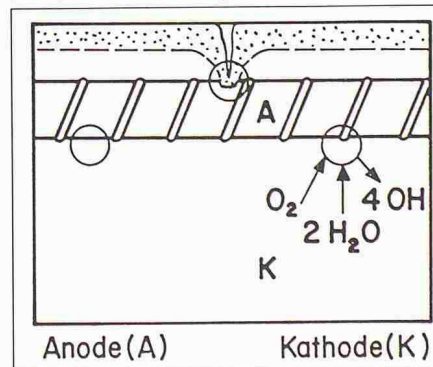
Korrosion des Bewehrungsstahls bei inhomogen versalzener Betonstruktur
